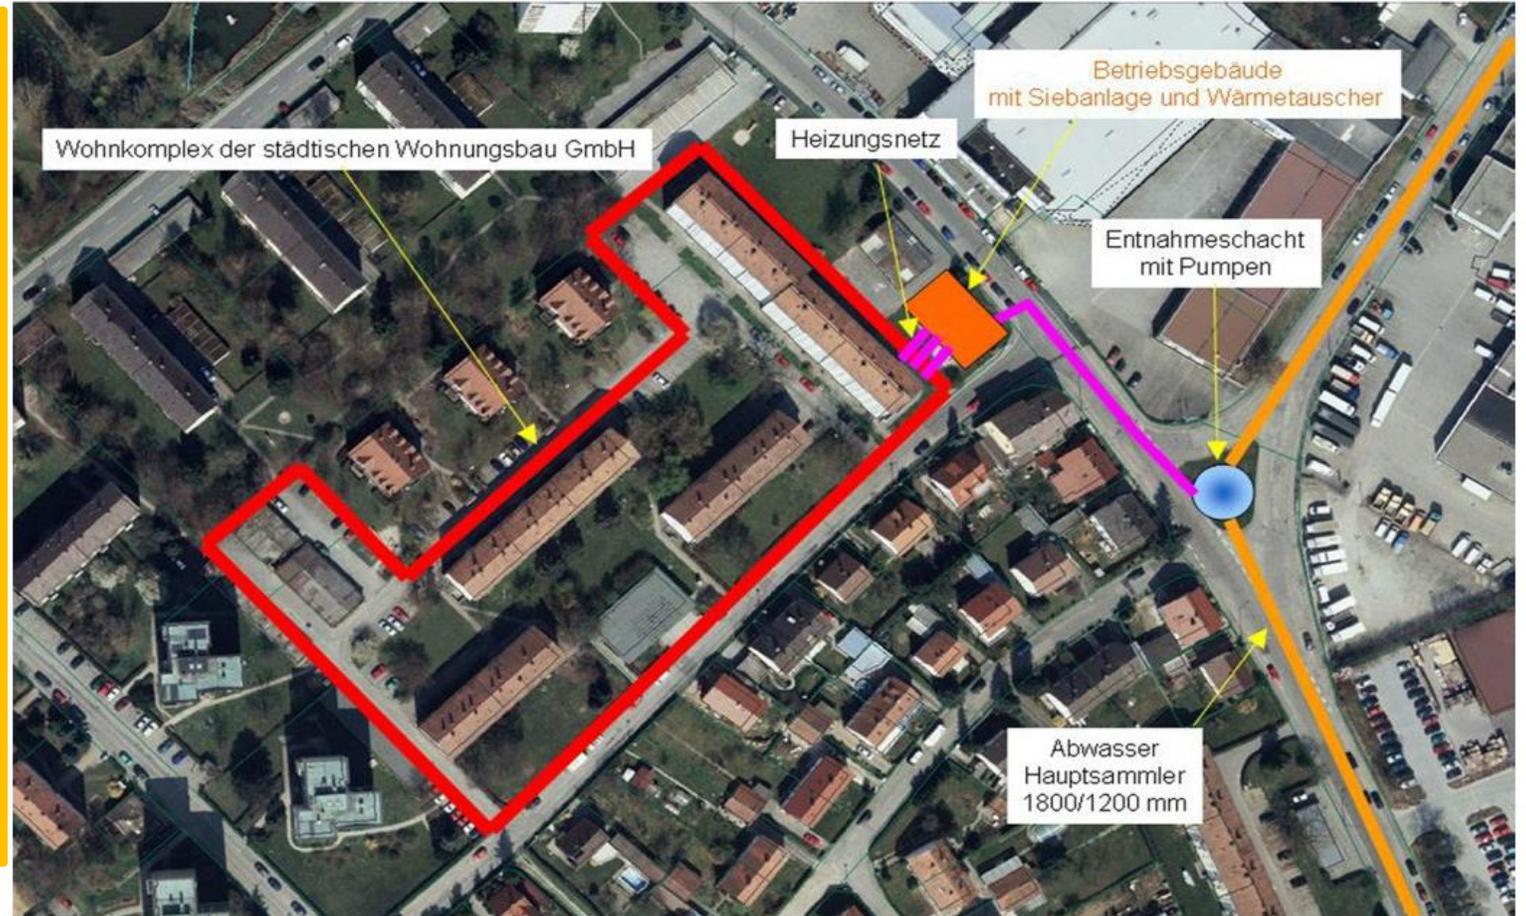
Lageplan Wohnhausanlage Straubing (Quelle Tiefbauamt Stadt Straubing, Dipl.Ing. (univ.) Christina Pop)
